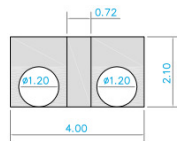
Vista da Ponte 02 – Prolongamento da Rua São João.
